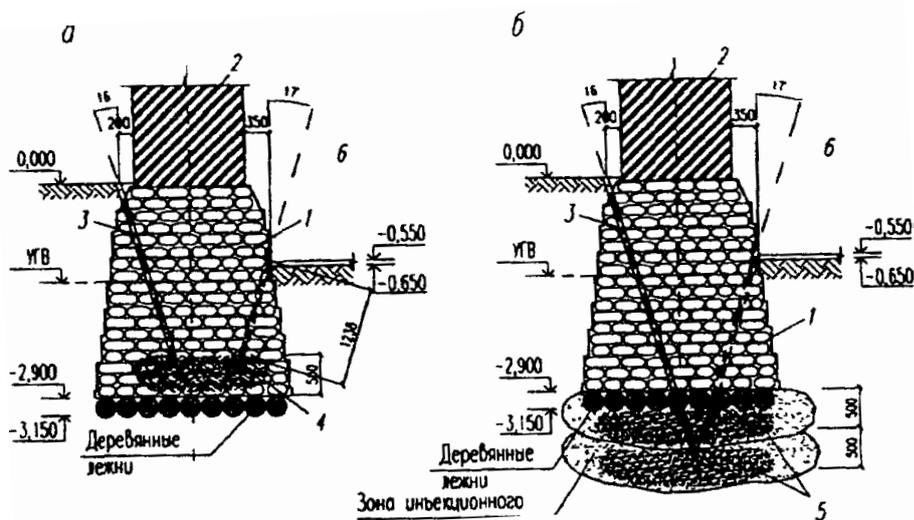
Инъекционное закрепление: а - кладки; б - грунта несущего слоя; 1 – фундамент; 2 - кирпичная стена; 3 - инъекционная скважина; 4 - полусгнившие лежни; 5 - массив закрепленного грунта; 6 - подвал
